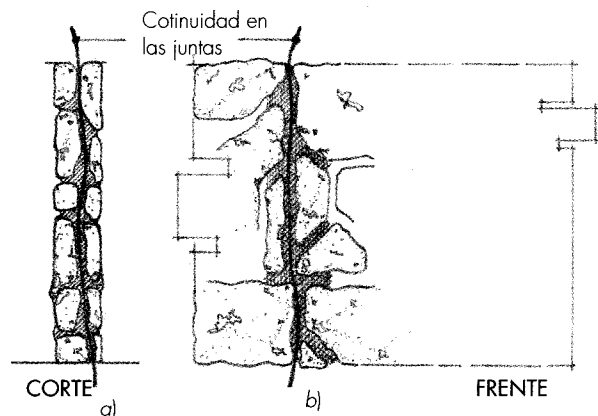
En *a* y *b* aparece un muro de piedra con las juntas sin cuatrapear, lo que da por resultado una mampostería incorrecta.
